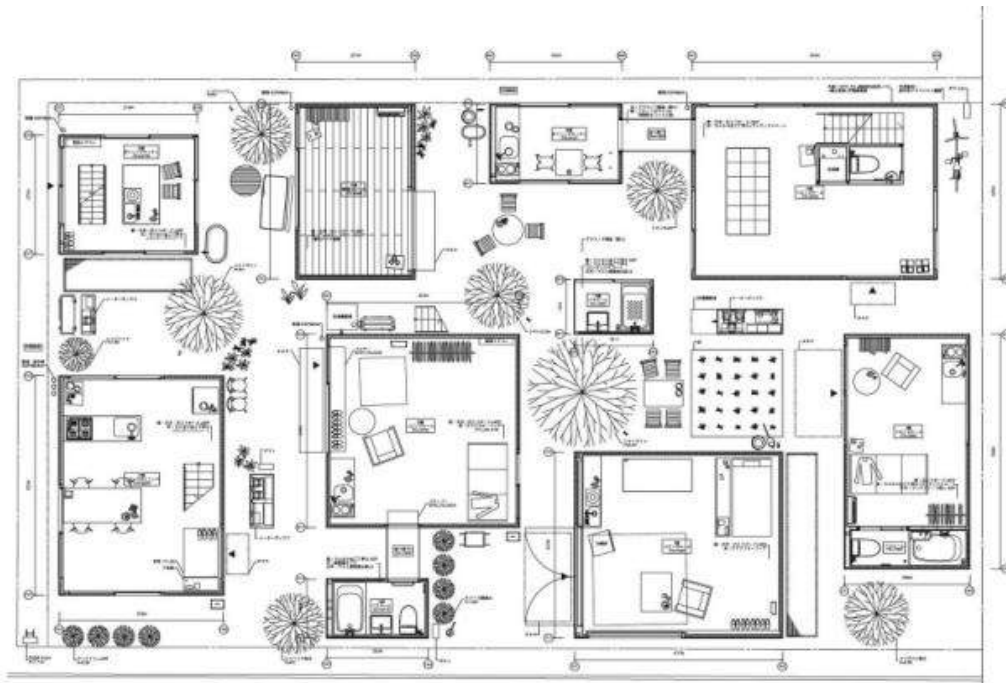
Blok massa Moriyama House (amassingdesign.blogspot.co.id, 2014)
